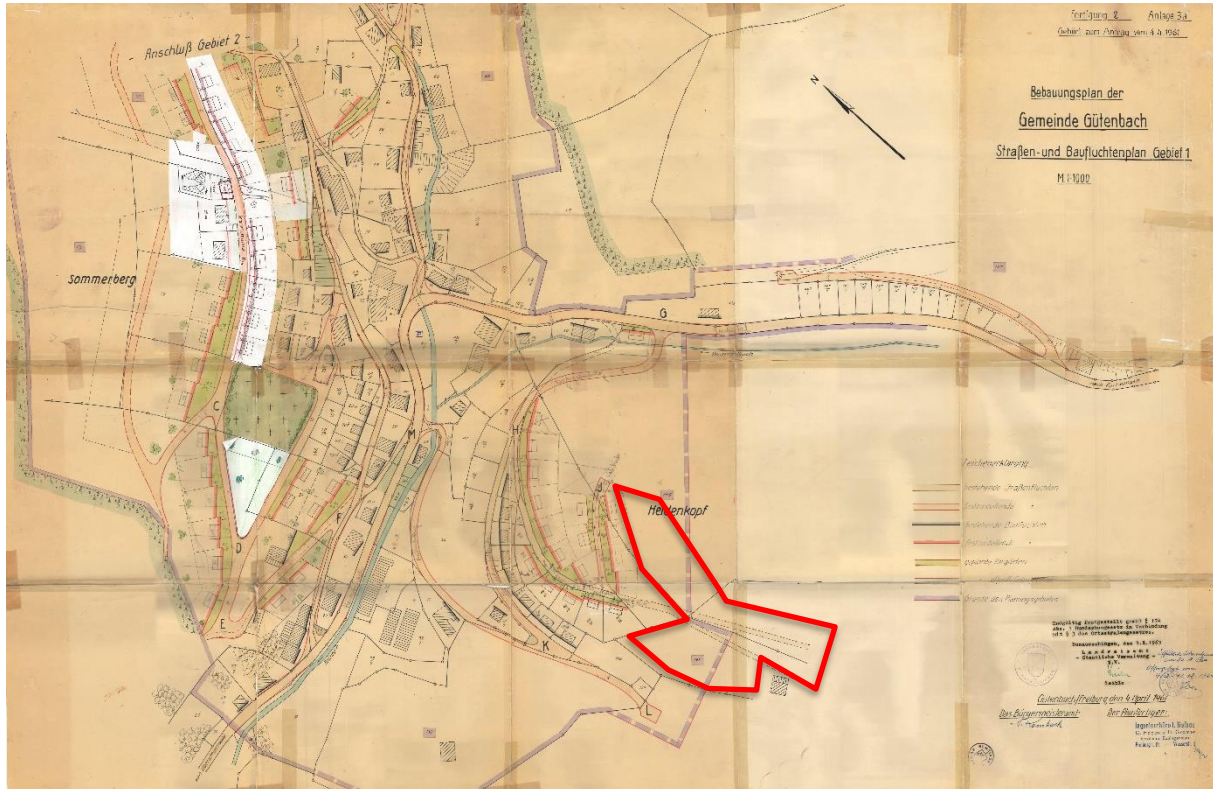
Bebauungsplan "Sommerberg-Heidenkopf", Straßen- und Bauflichtenplan, rechtsverbindlich seit dem 04.12.1964; Quelle: <https://rasbk.maps.arcgis.com>; eigene Darstellung
